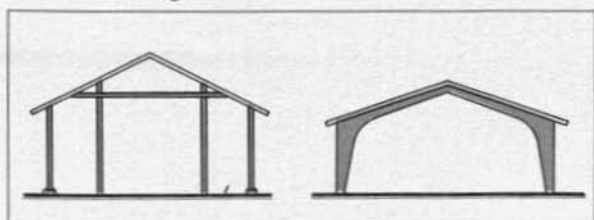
Holzkonstruktionen für Skelettbauweise; (l) Ständerkonstruktion, (r) Leimbinderkonstruktion
